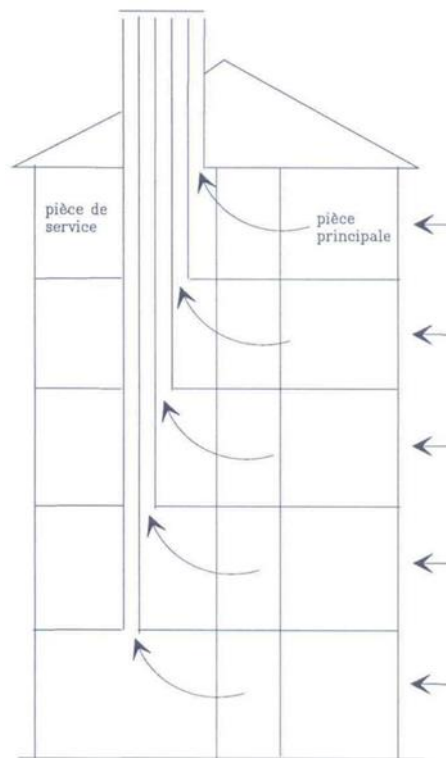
Ventilation par conduits à tirage-naturel détails des types de conduits de haut en bas [25]
